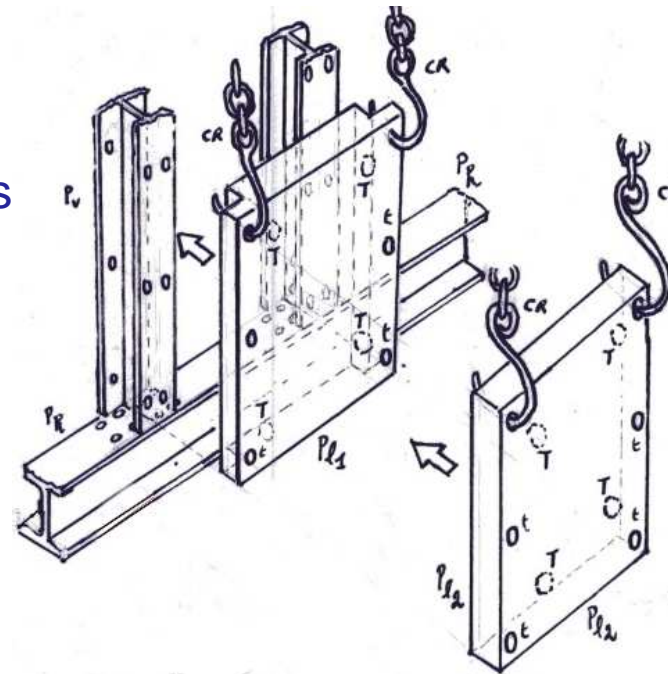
Pose de deux types (PI1)(PI2) de modèles de plaques (ayant deux types différents de section) sur les poutres métalliques de la variante1.
